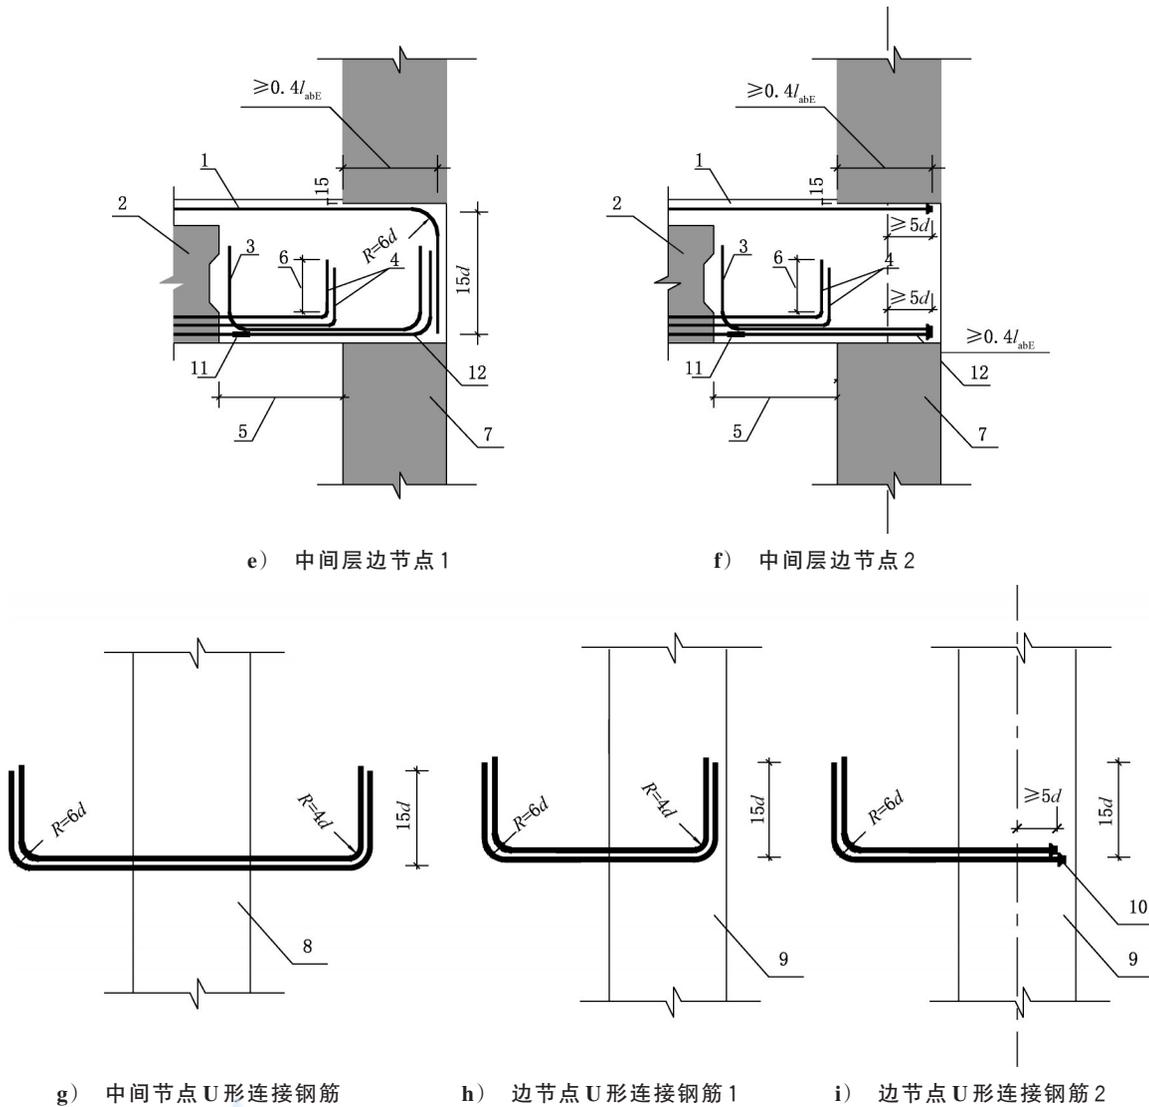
无凹槽梁柱节点浇筑前钢筋连接构造示意
